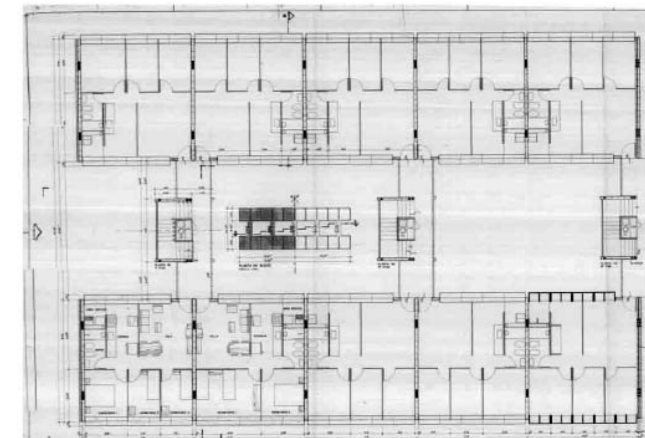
Planta do conjunto. Fonte: Instituto Lina Bo e P. M. Bardi.
